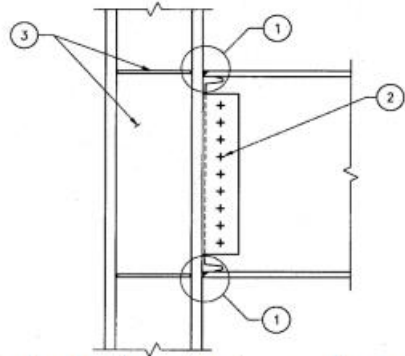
Aleta soldada sin refuerzo – alma pernada
